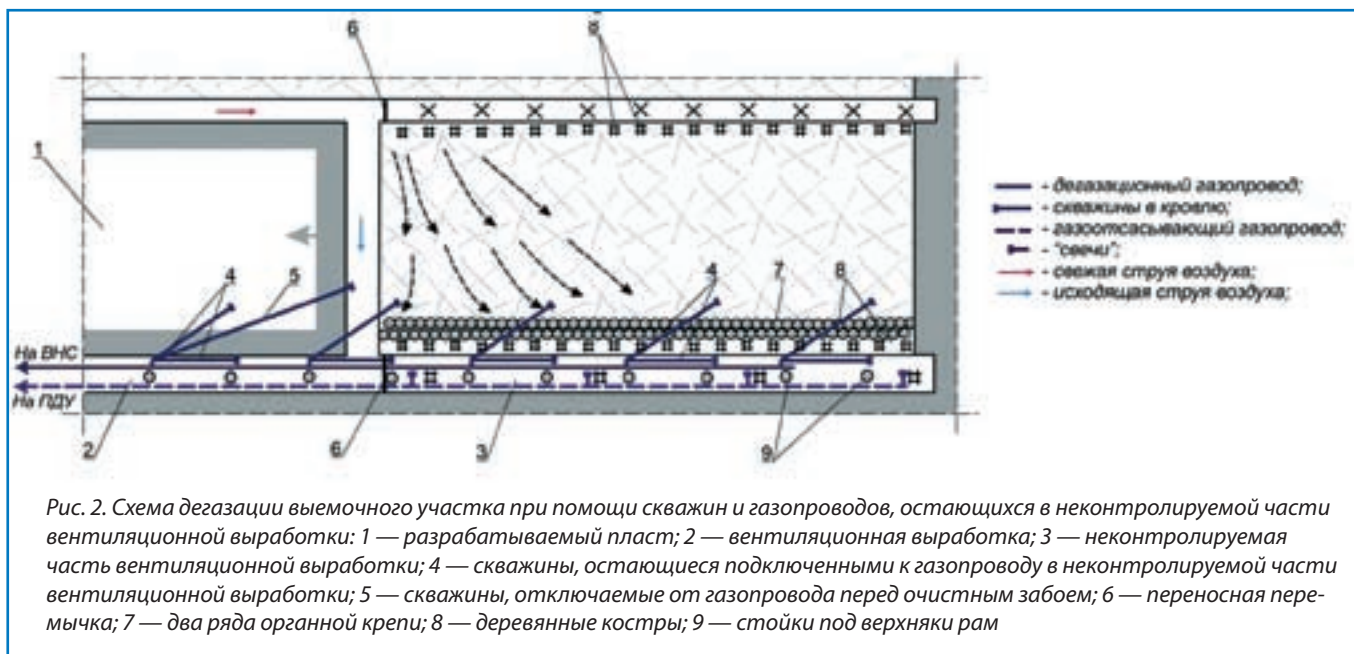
Схема дегазации выемочного участка при помощи скважин и газопроводов, остающихся в неконтролируемой части вентиляционной выработки: 1 — разрабатываемый пласт; 2 — вентиляционная выработка; 3 — неконтролируемая часть вентиляционной выработки; 4 — скважины, остающиеся подключенными к газопроводу в неконтролируемой части вентиляционной выработки; 5 — скважины, отключаемые от газопровода перед очистным забоем; 6 — переносная переключатель; 7 — два ряда органной крепи; 8 — деревянные костры; 9 — стойки под верхняки рам
